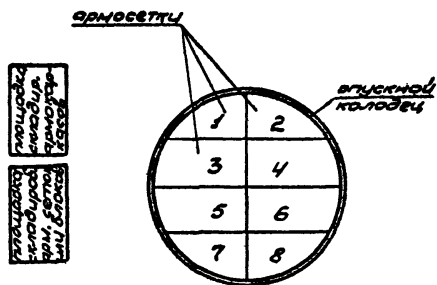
Схема последовательности укладки арматурных сеток (нижних и верхних) или блоков дна колодца
